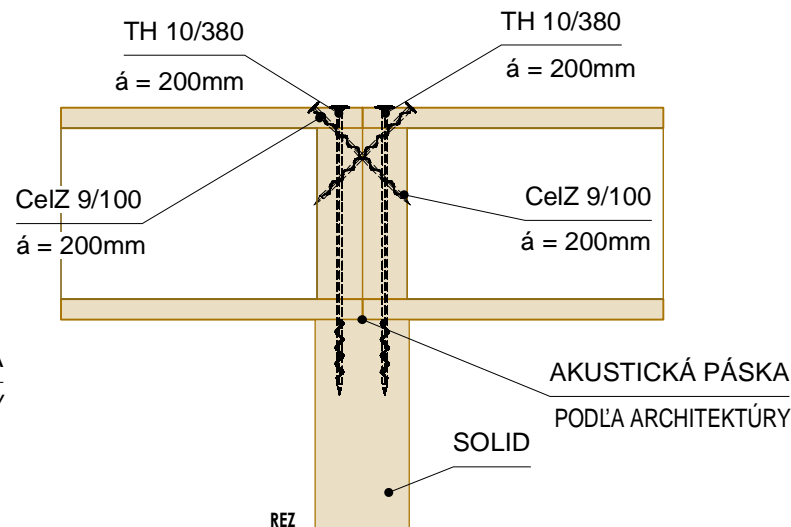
DETAIL "N" - NAPOJENIE ELEMENT 280 NA ELEMENT 160
